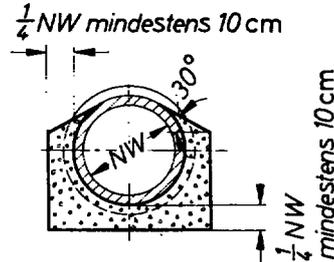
Ausführungsbeispiel einer Teilummantelung mit Beton
